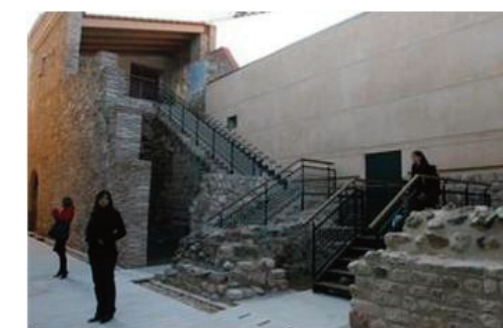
Restauración de tapial mediante hormigón de cal hidráulica como encofrado, obra de Moreno-Navarro
